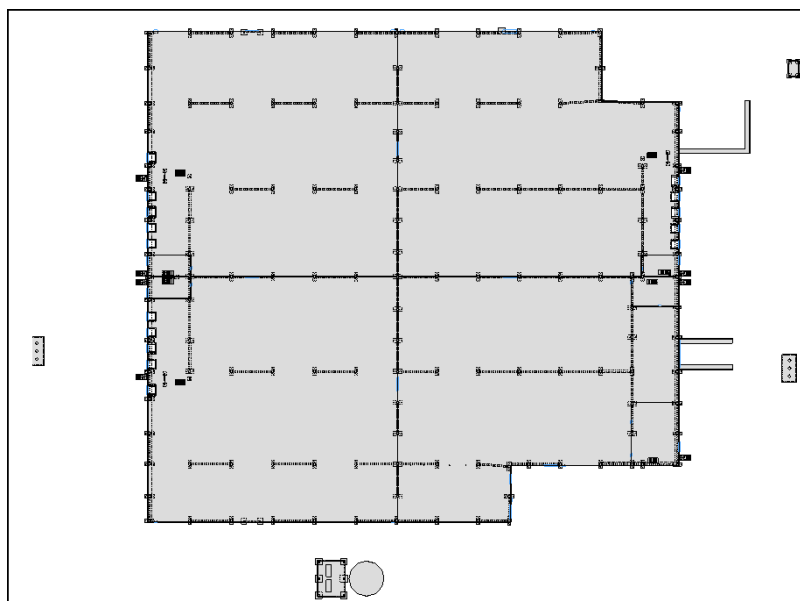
Planta de fundações do edifício extraída do modelo de estruturas
